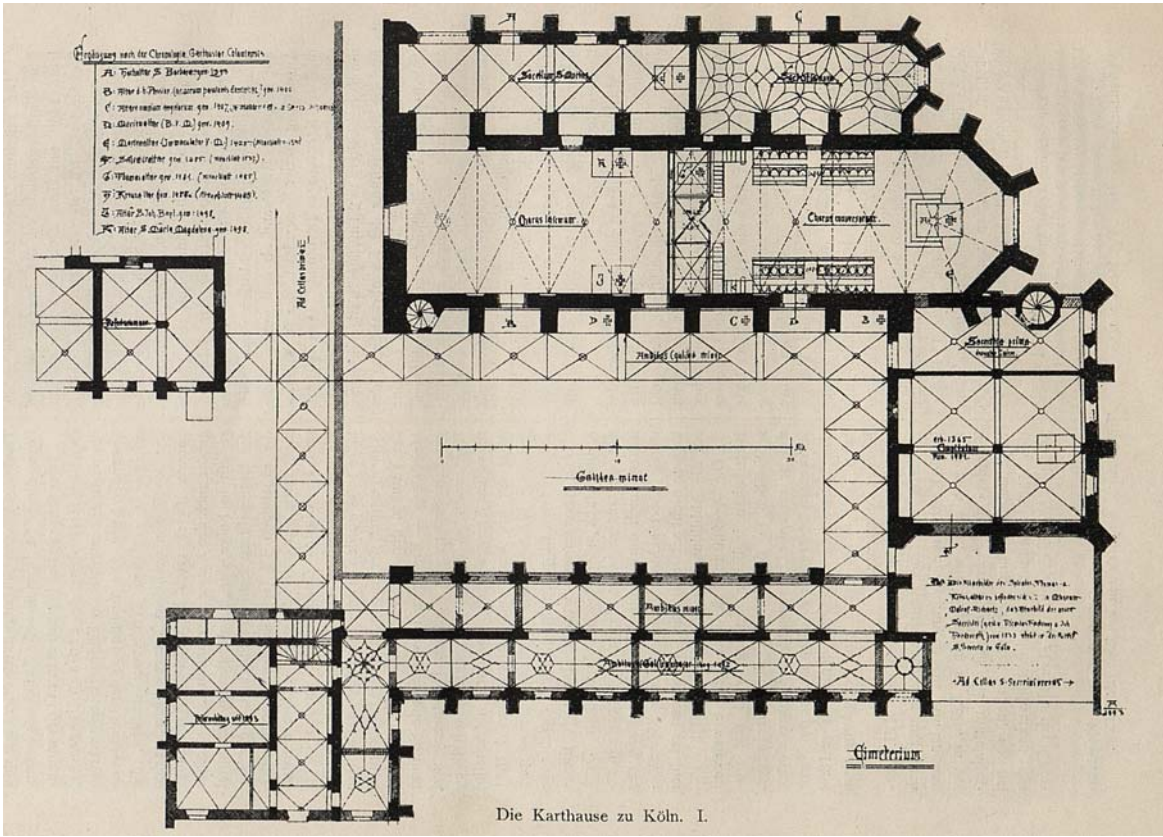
Ludwig Arntz – Grundriss der Kölner Kartause St. Barbara
